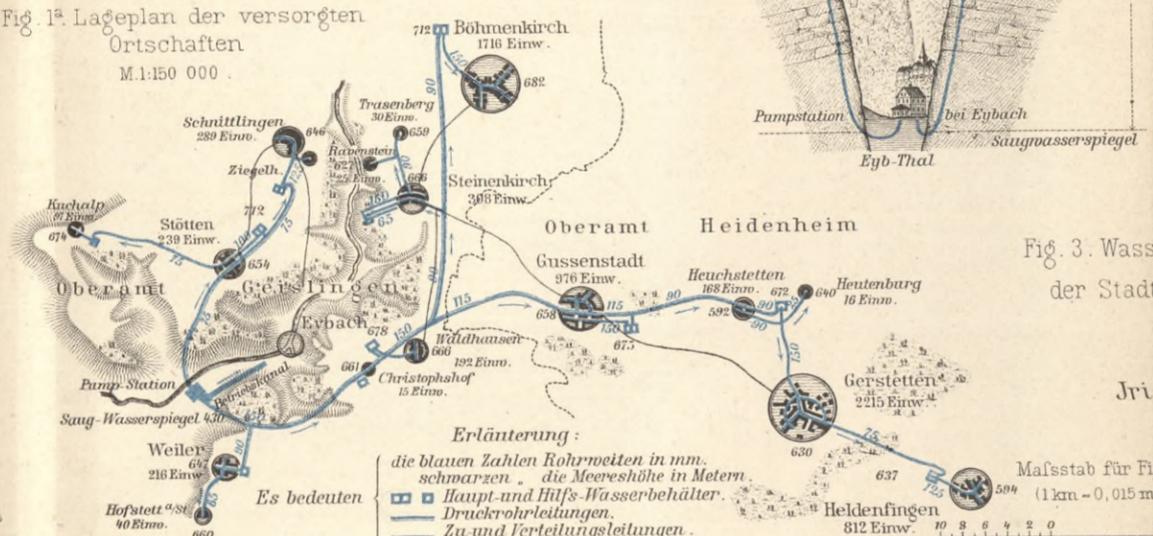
<sup>a</sup> Lageplan der versorgten Ortschaften
